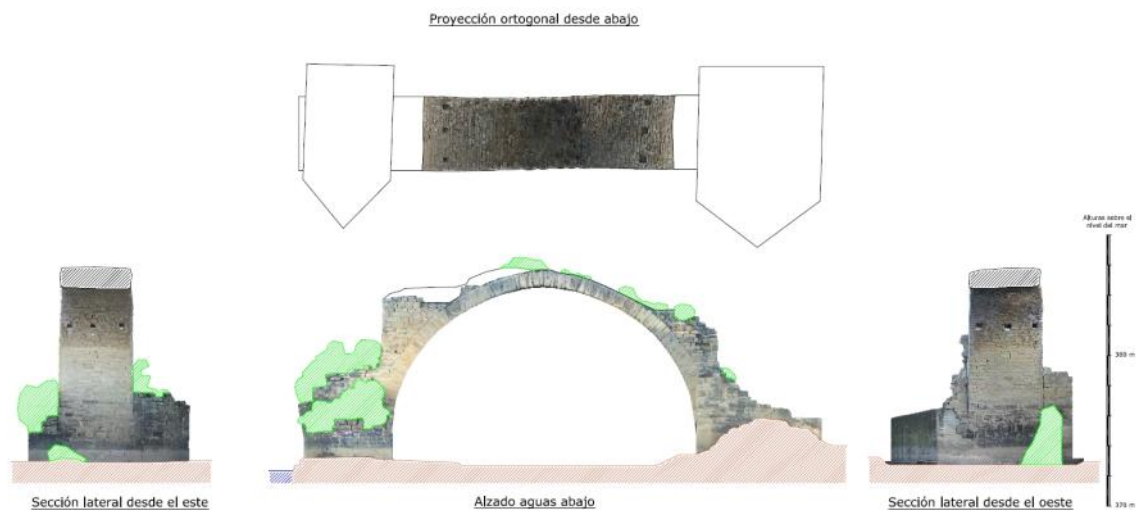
Alzado aguas abajo y vistas ortogonales del interior del arco.
